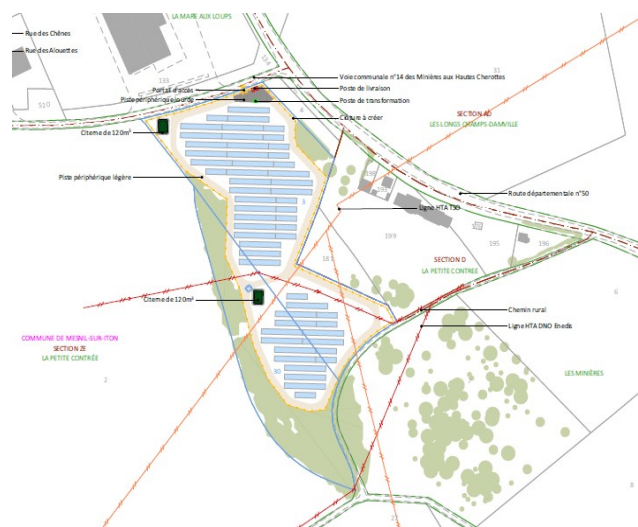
plan d'implantation (source : DPC02 Plans de masse).
